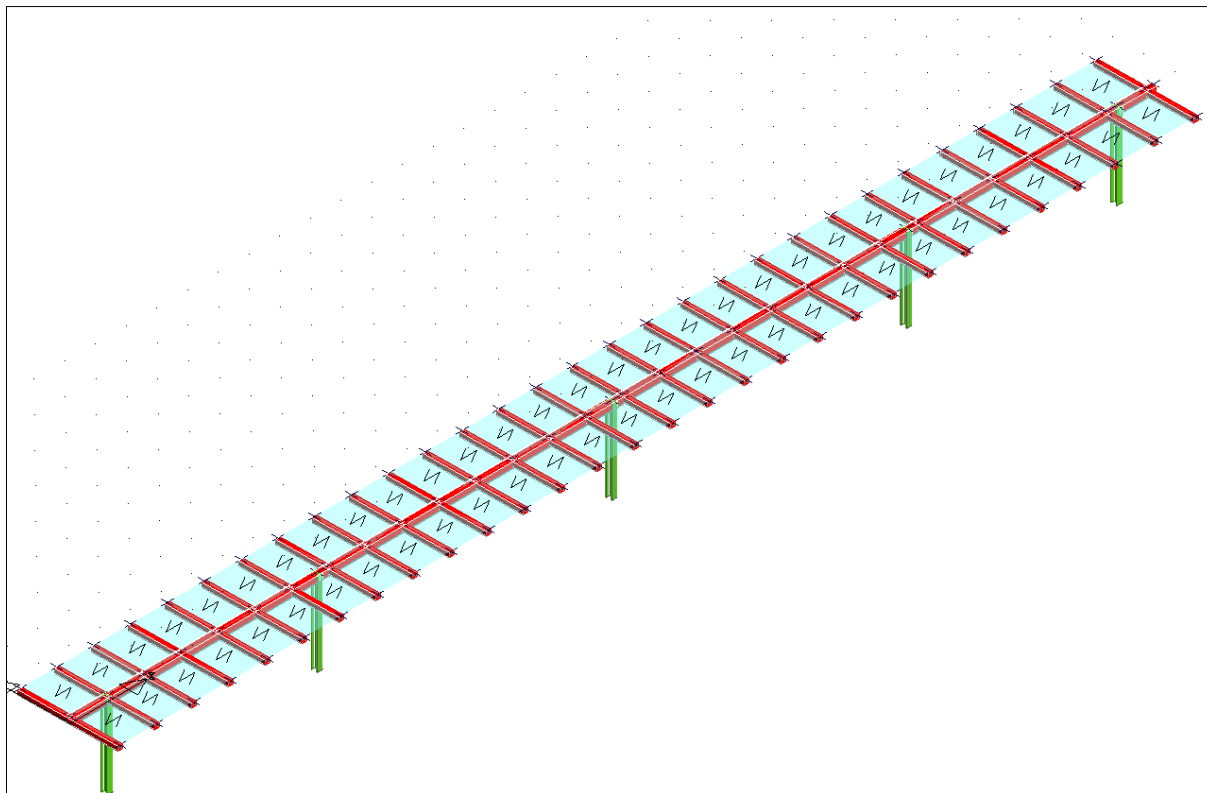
Vista assometrica modello strutturale con posizione della “vela” orizzontale
